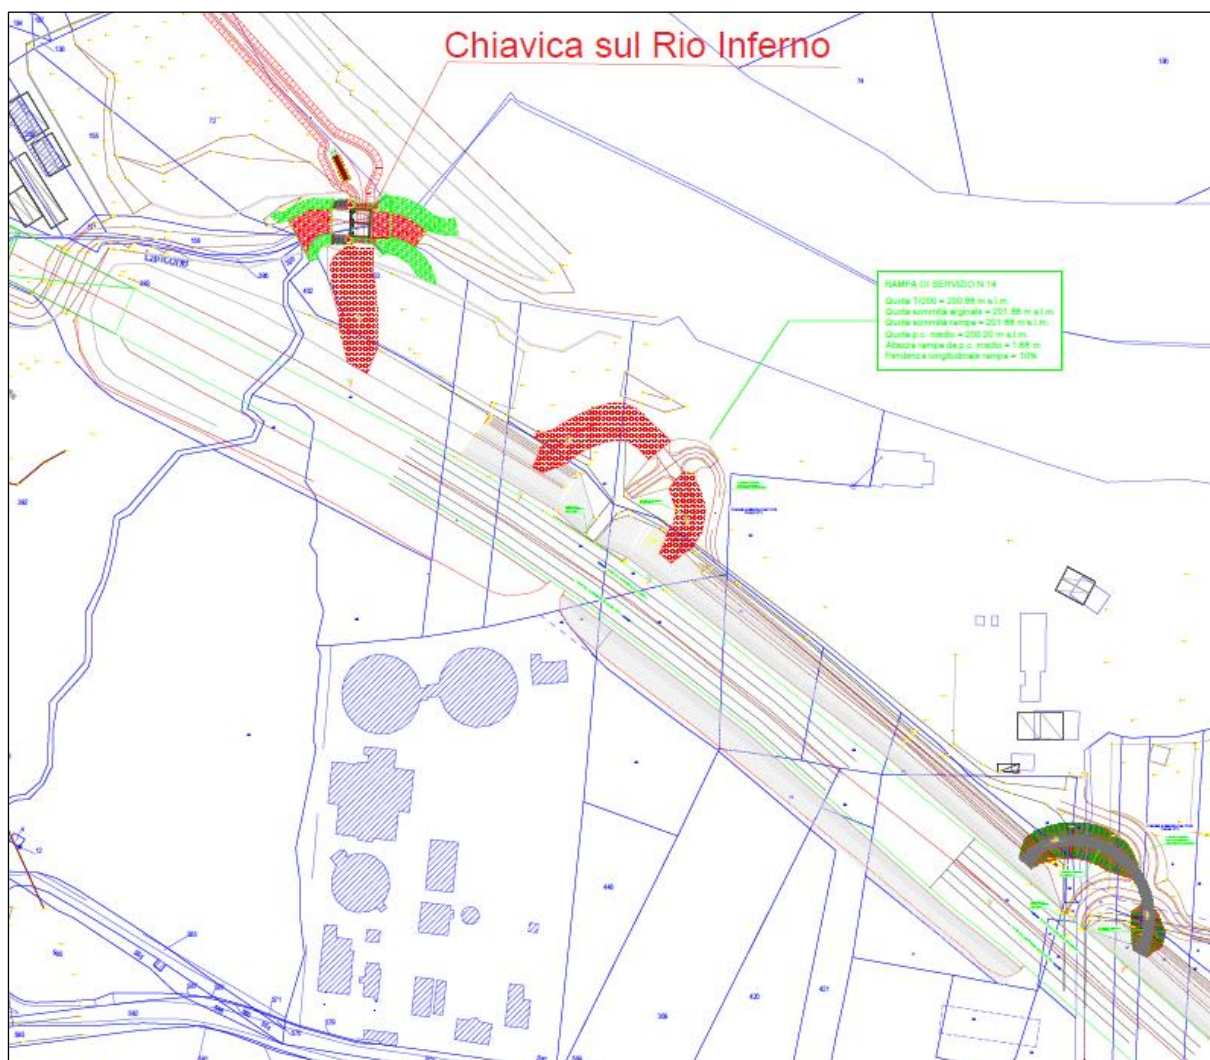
Planimetria delle opere in progetto nei pressi del depuratore di Gravellona Toce, modificata nel corso delle attività di realizzazione delle opere
